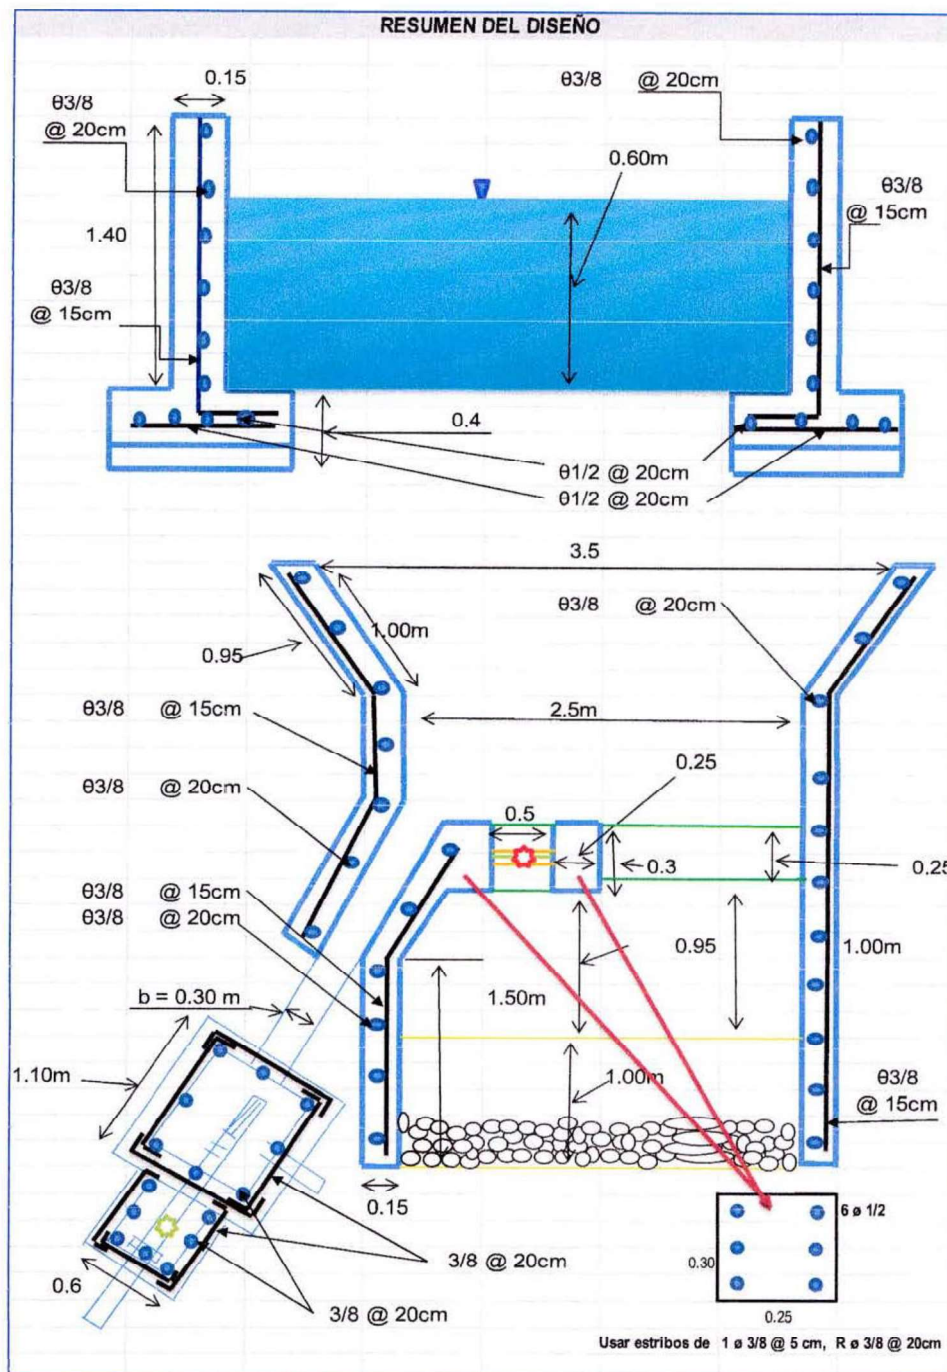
PLANTA Y PERFIL CAPTACION
